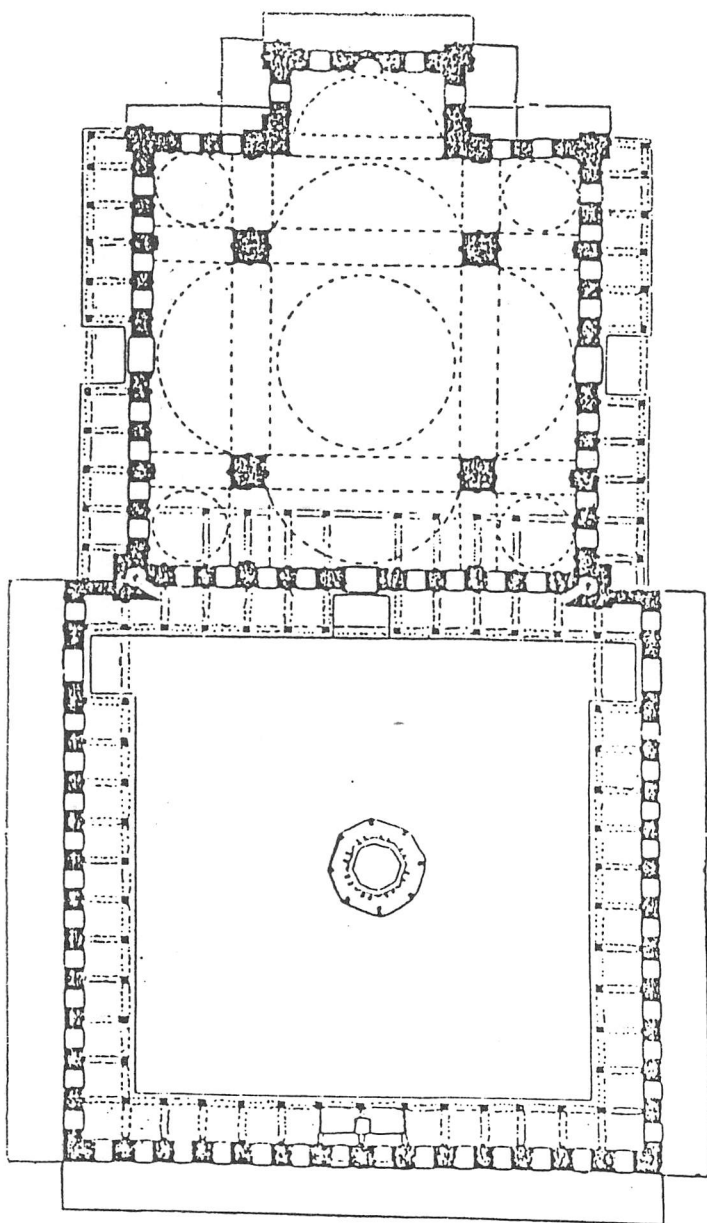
المسقط الأفقي لجامع لاله لي في إستانبول .
